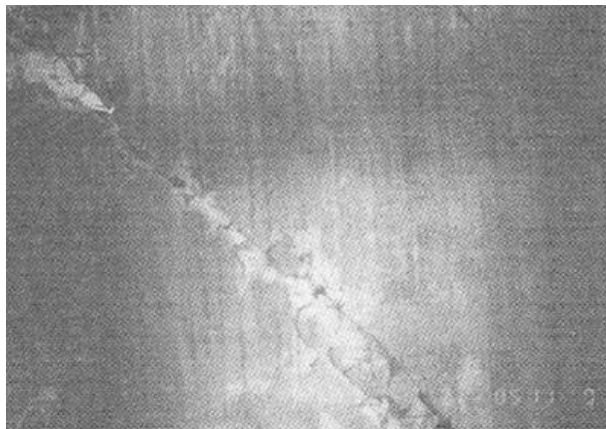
Muro estructural de concreto reforzado que falló por cortante (Masaki et al., 1996)
